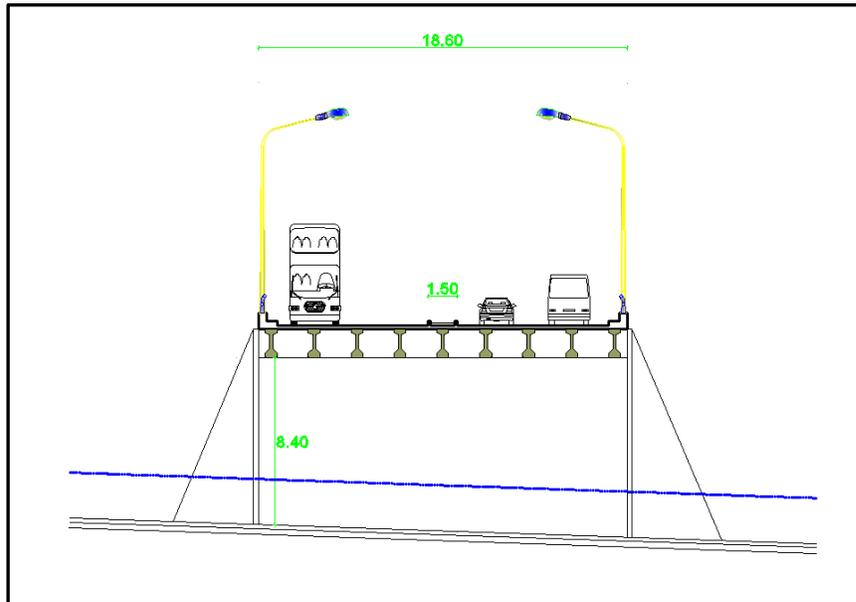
Sección puente elevado “Las Brisas”, Prog. 0+000. Propuesta elaborada por los ingenieros civiles Carlos Espinoza y Rogelio Pérez (2013)
